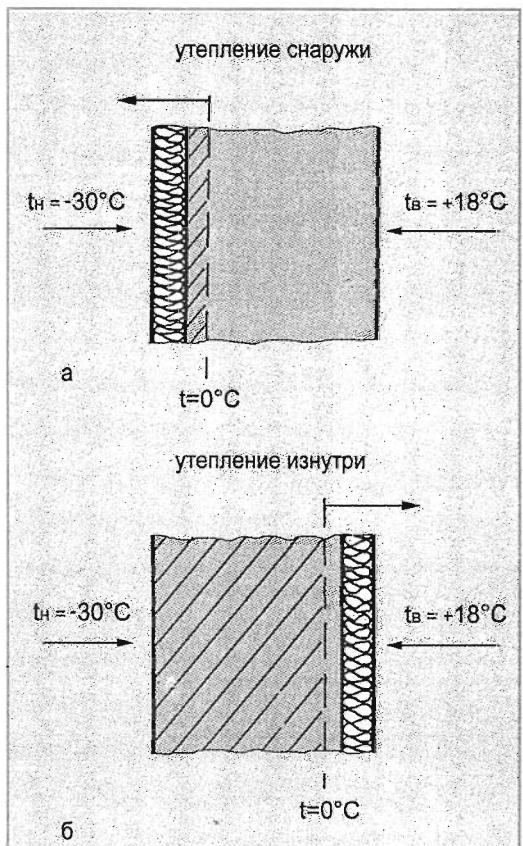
Пример размещения утеплителей с наружной и внутренней сторон стен: а – размещение утеплителя с наружной стороны стены сдвигает изотерму нулевых температур к наружной поверхности, зона промерзания стены (заштрихована) стремится к нулю; б – размещение утеплителя с внутренней стороны стены сдвигает нулевую изотерму к внутренней поверхности стены, зона промерзания стремится занять всю толщину стены
